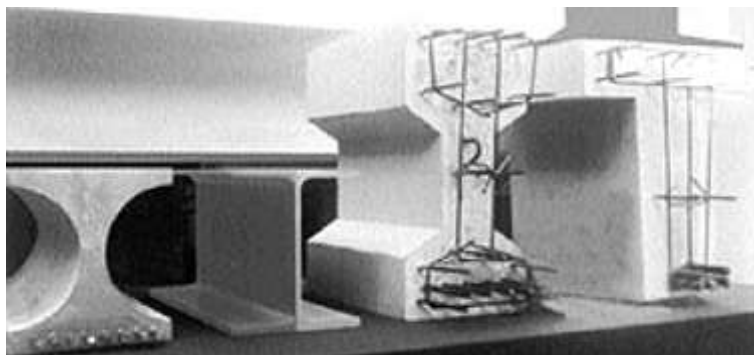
Secciones de vigas. Fuente: Soutsos Millard.
